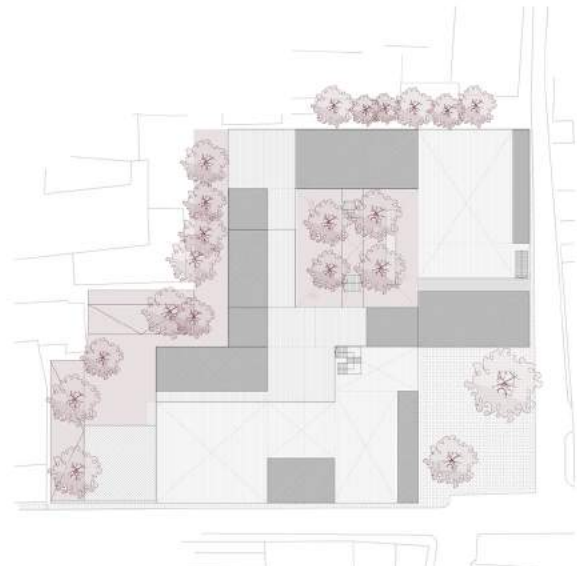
Planta de bloques estructurales del proyecto desarrollado. Elaboración propia.
